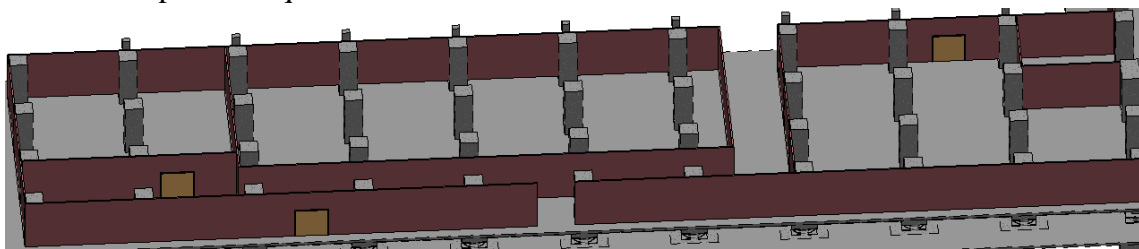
Construcción de muros divisorios- Pabellón A (HERM-Revit)
